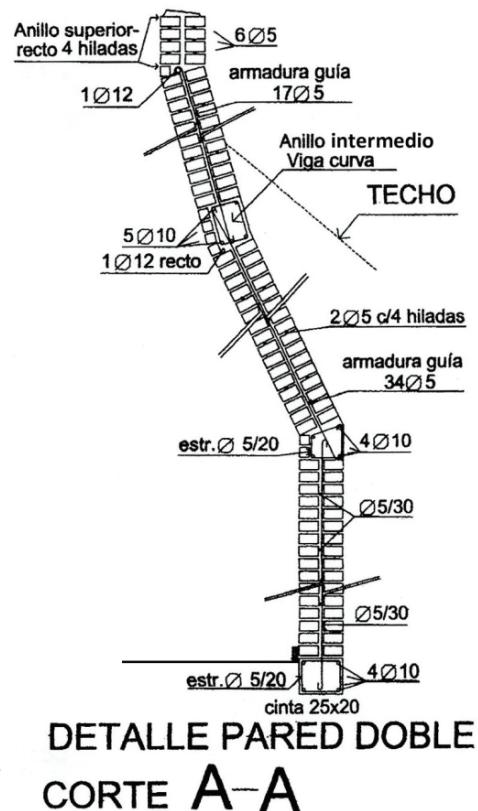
Corte detalhe. Observe de baixo para cima a viga baldrame, o anel na junção da parede curva com a inclinada. Mais acima o anel intermédio e no topo o anel superior com 4 fiadas de tijolo armado. (*-5).
